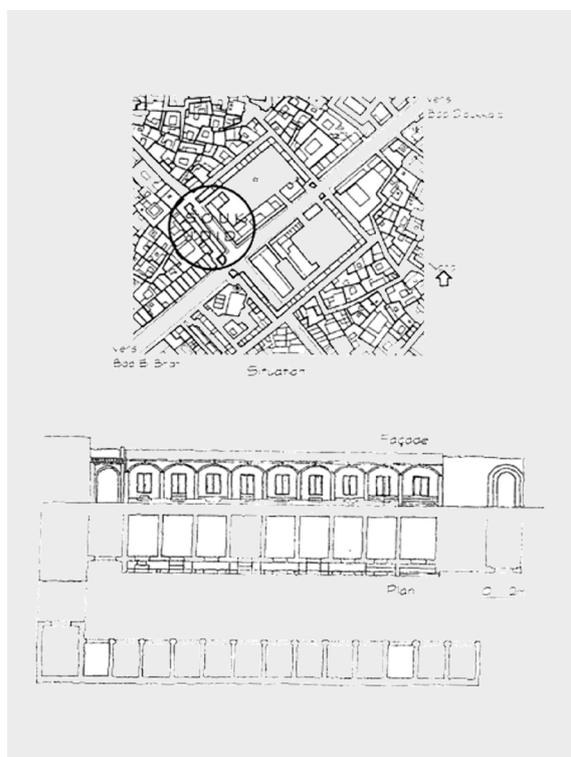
Städtebaulicher Lageplan und Grundriss bzw. Fassadenansicht der Marktbuchten des Souk Centrale
